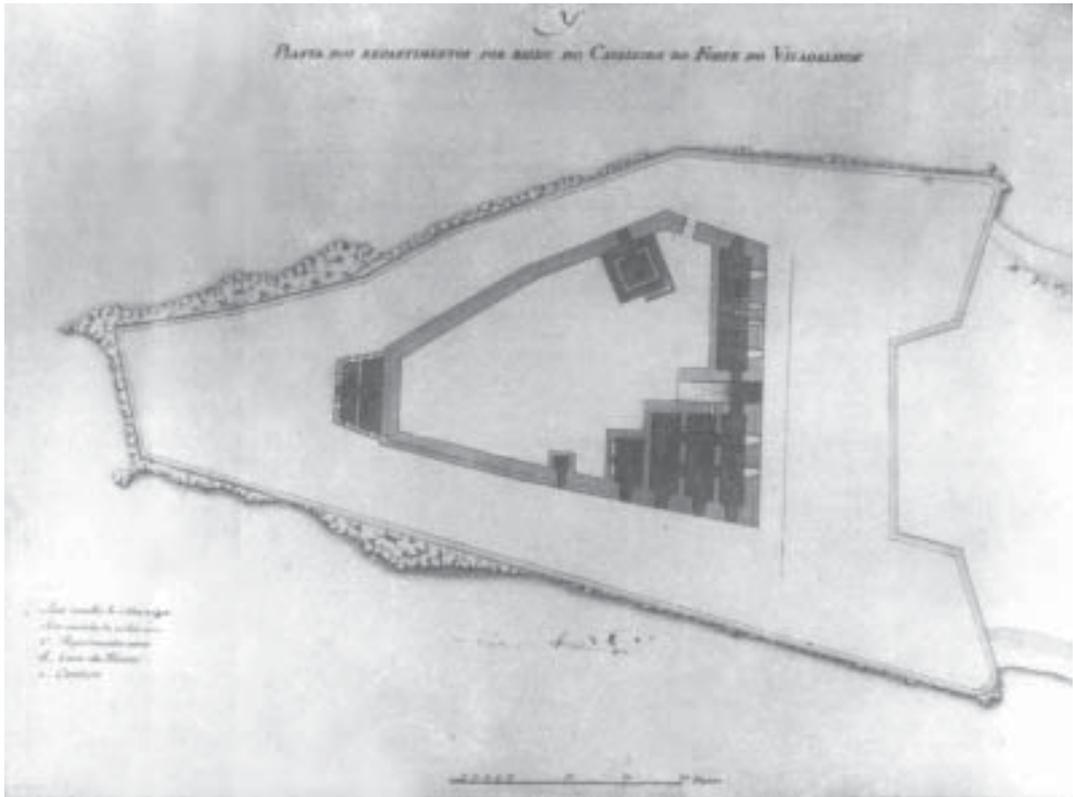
Planta da parte inferior do Forte de Villegagnon – Jacques Funck, 1781
